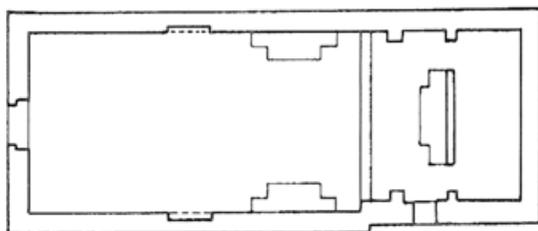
Pianta della pieve di San Giovanni Battista alla Nera
